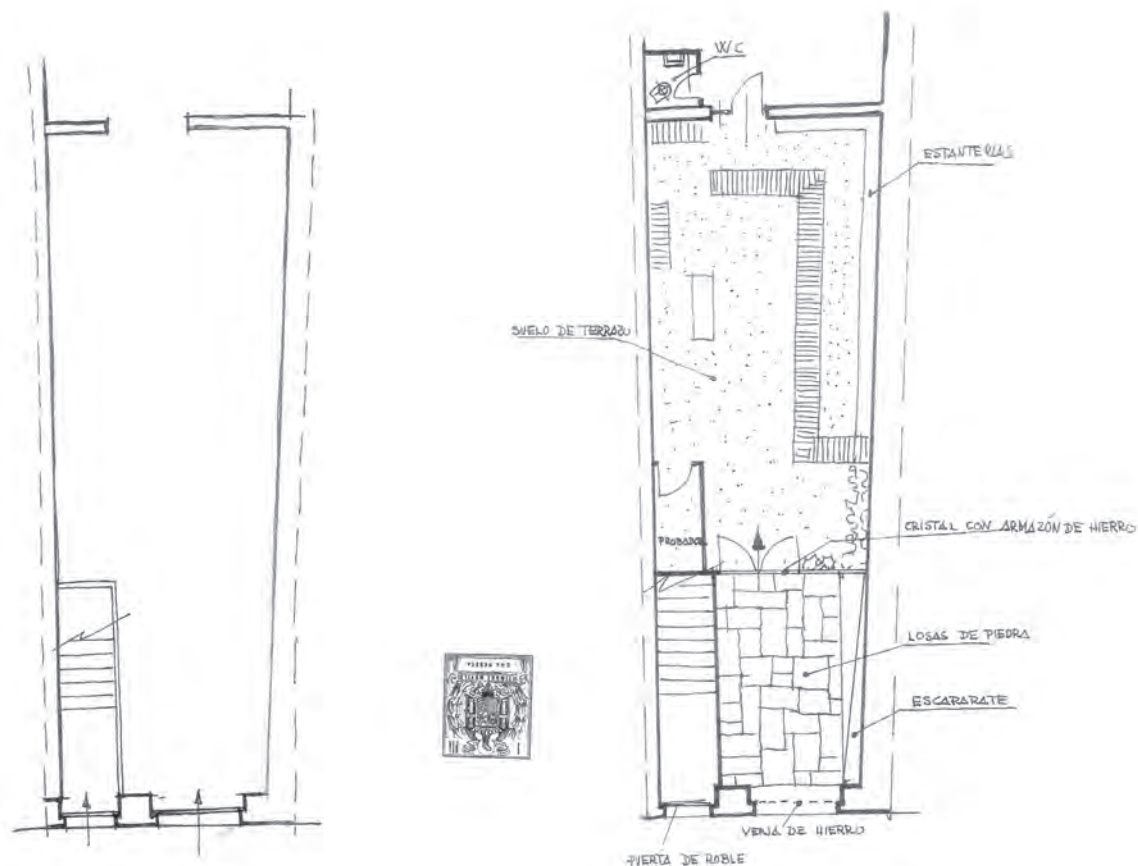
17. 1962 PLANTA BAJA. ESTADO ANTERIOR A REFORMA Y POSTERIOR
